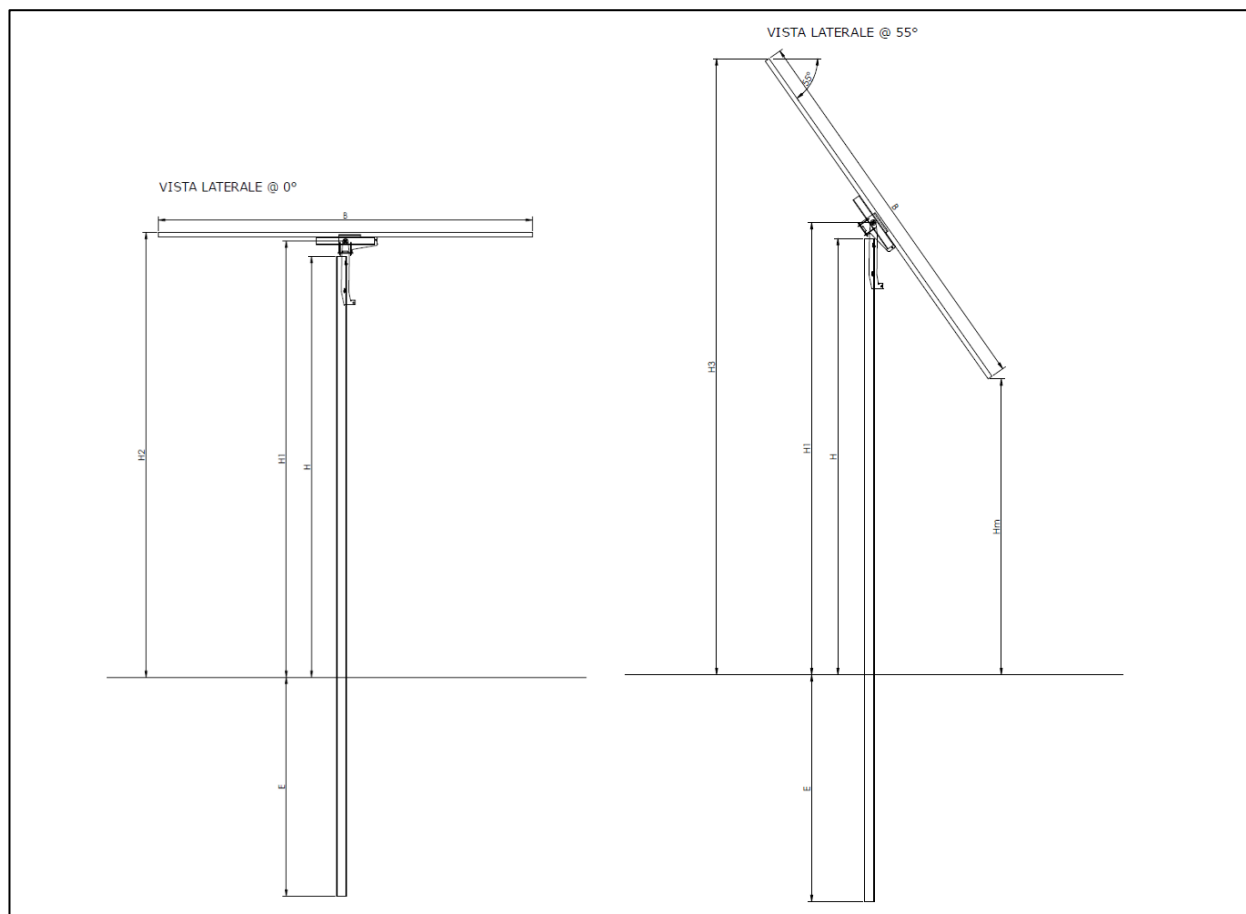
/III: Schema grafico delle strutture (struttura ad inseguimento, vista laterale)
